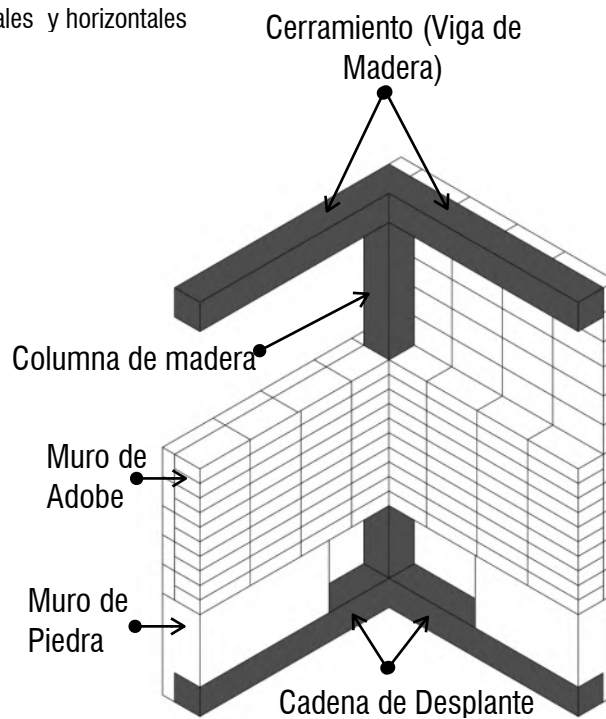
Isométrico de muro y refuerzos verticales y horizontales
